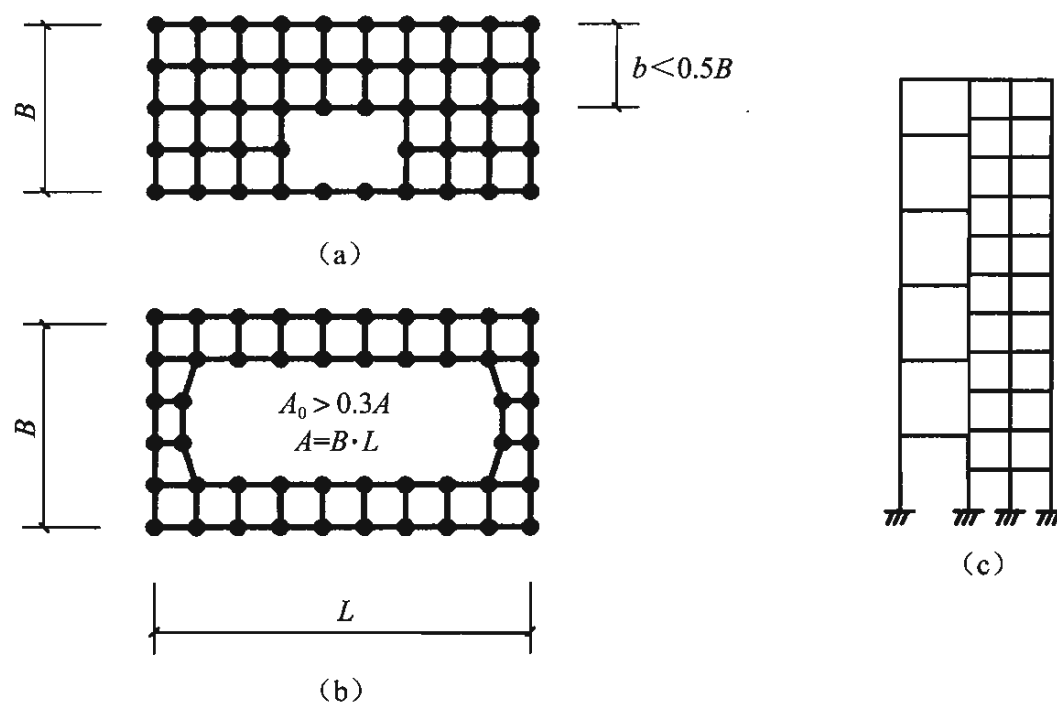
建筑结构平面的局部不连续（大开洞及错层）
